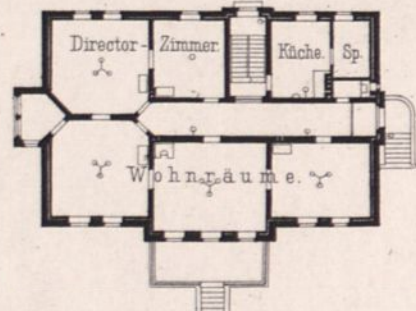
Director-Wohnhaus. Grundriss des Erdgeschosses.
